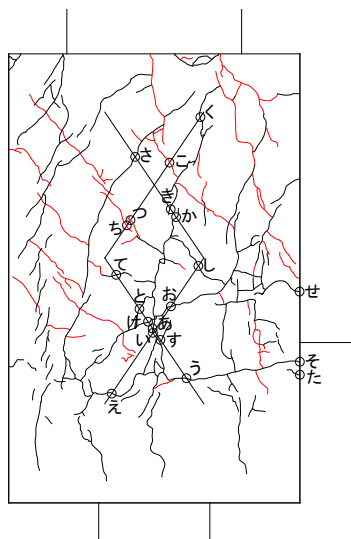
パイルキャップひび割れ幅測定位置 (試験体 A-7a 負荷荷)
